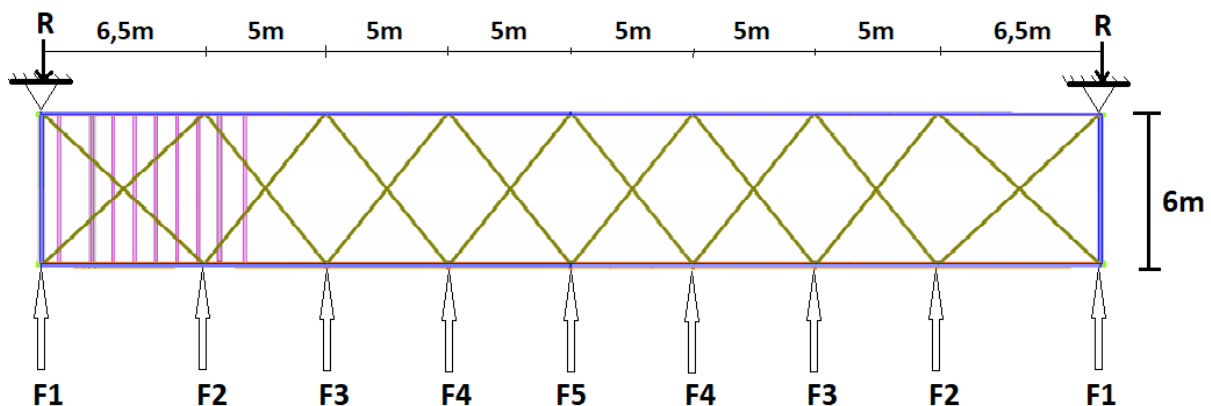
Schéma statique de la poutre au vent (effet de traction).
